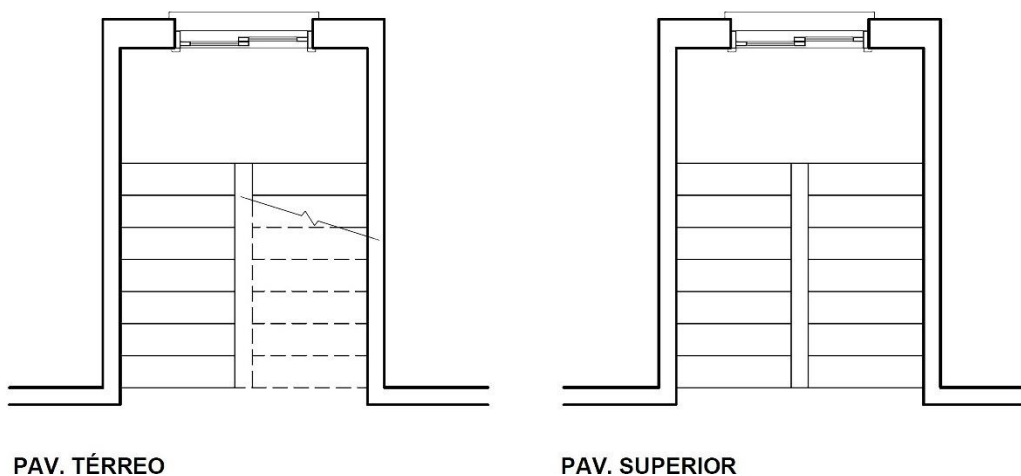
2º passo na representação de uma escada em planta baixa. Fonte: autor
